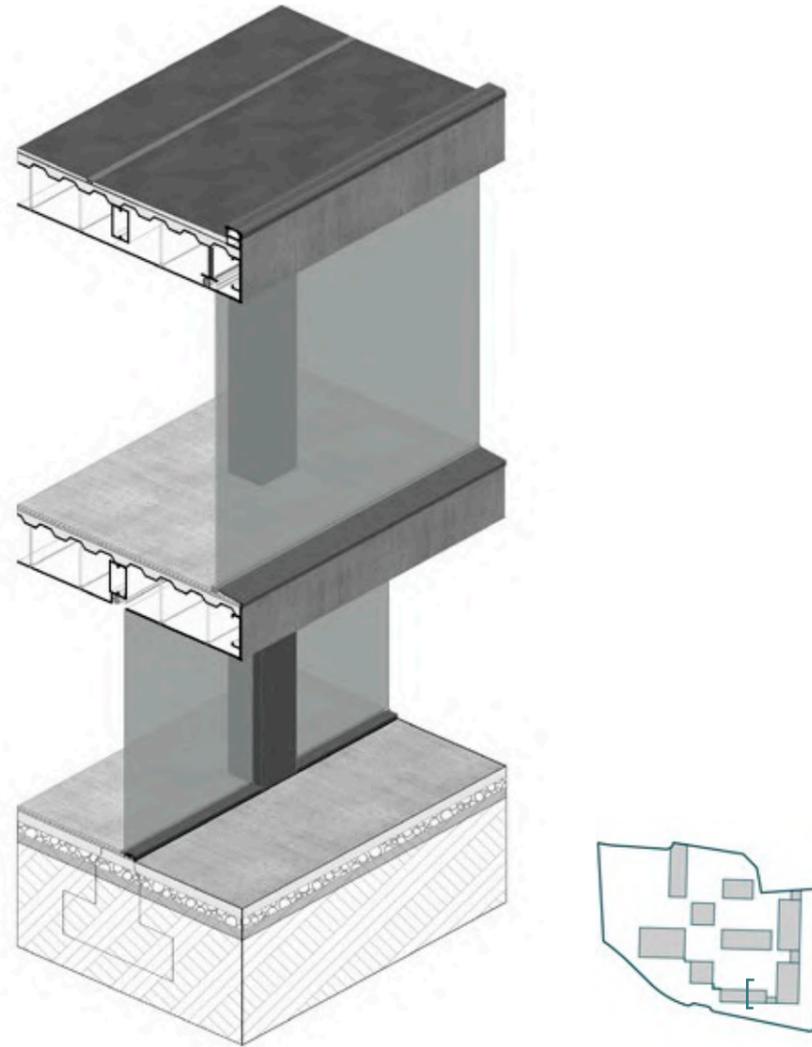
| Elevación, sección y detalles aulario administración/ biblioteca | Fuente: Elaboración Propia
